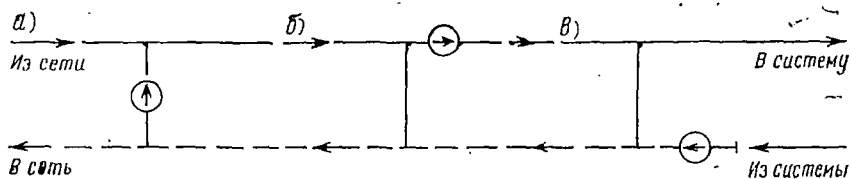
Принципиальные схемы присоединения системы напольного отопления к тепловой сети с подмешивающим насосом:
